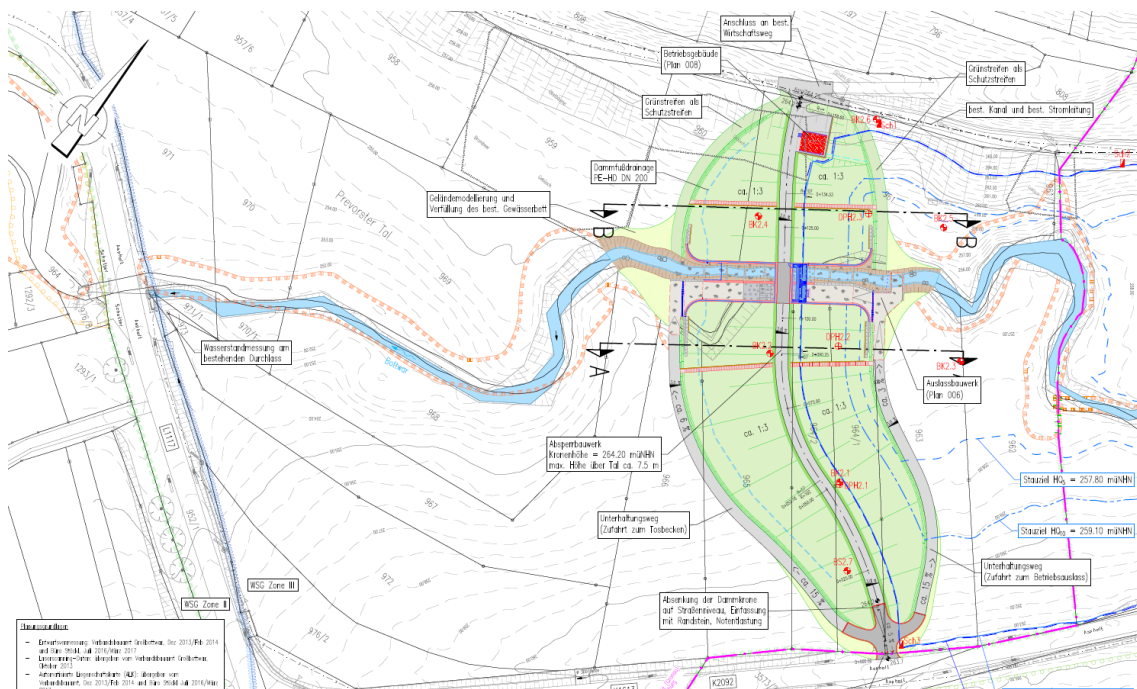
Unmaßstäblicher Lageplan des Dammbauwerkes mit Wasserstandsmessung an bestehendem Durchlass der L 1117 (Detaillierter Darstellung siehe Unterlagen Teil B Plan 004, INGENIEURBÜRO WINKLER UND PARTNER, 2019/2020)
